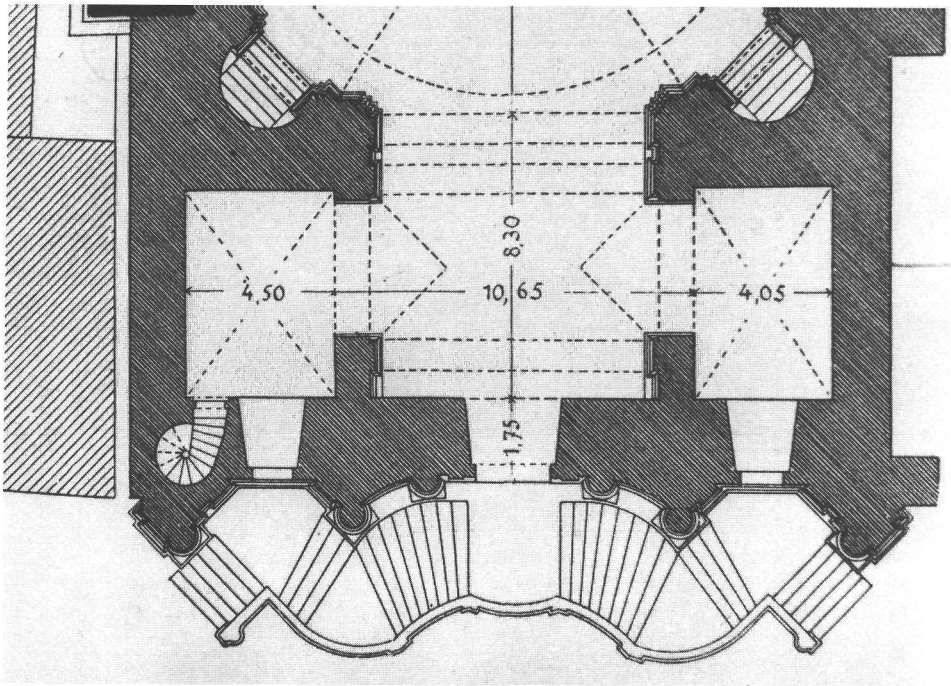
Würzburg, Neumünster. Fassadengrundriß der 1716 vollendeten Barockfassade im Kürschnerhof.
